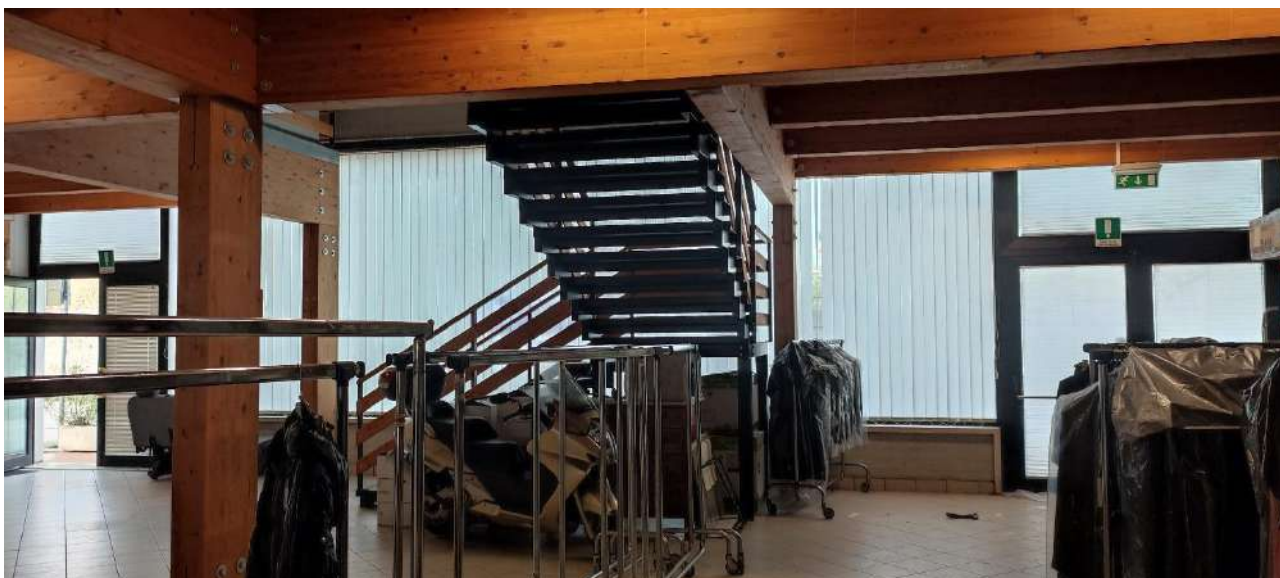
Vista interna - Intradosso sopralco con vista di apparecchio di distribuzione aria calda
